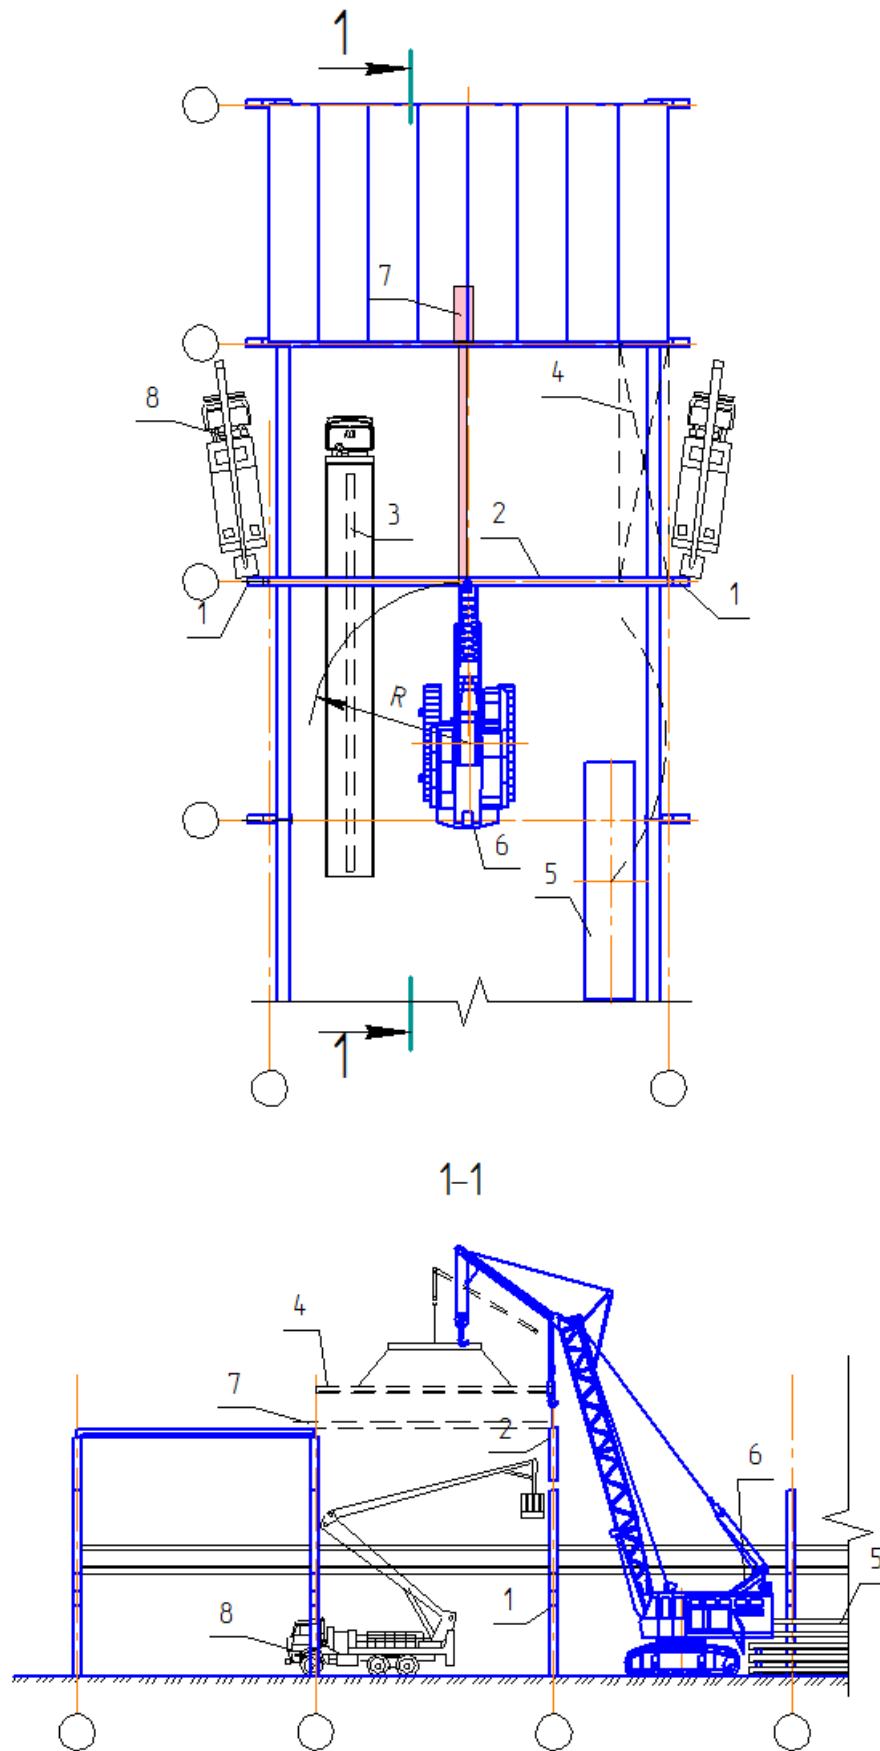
Схема монтажа ферм и плит покрытия одноэтажного промышленного здания:
